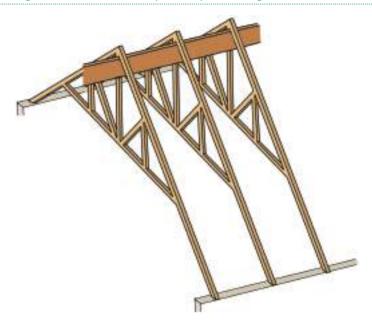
a. Stabilisation par une poutre longitudinale horizontale
